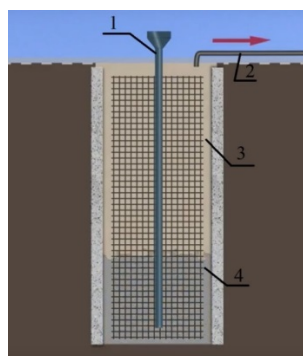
Бетонирование: 1 – бетонолитная труба; 2 – установка для откачивания бентонитовой смеси; 3 – бентонитовая смесь; 4 – бетон
